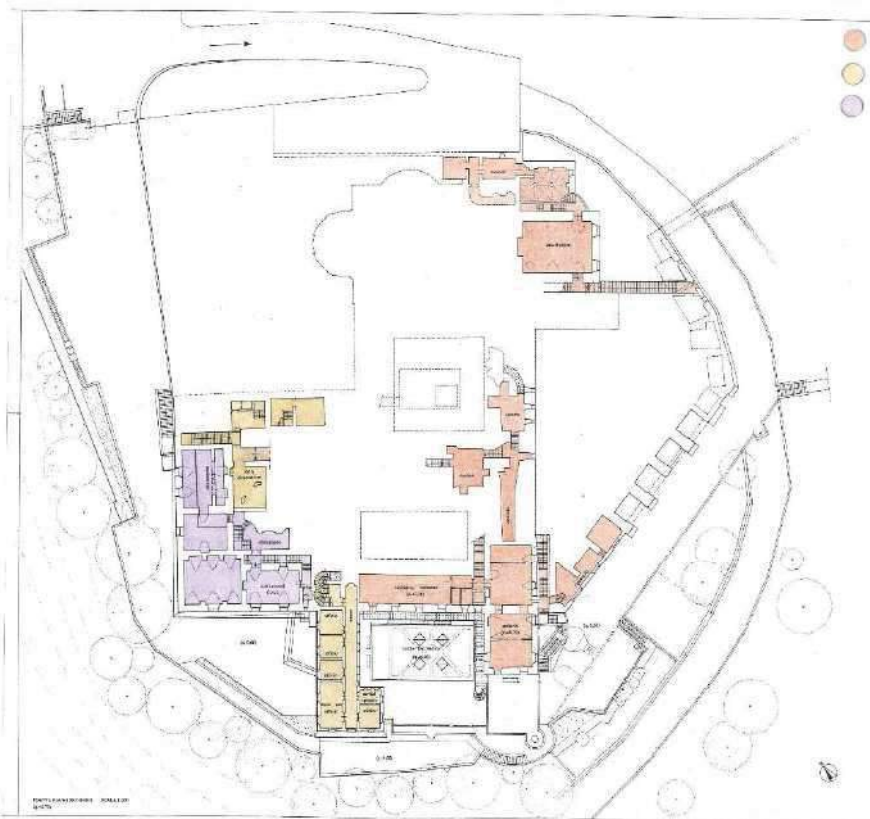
Pianta piano seminterrato; in giallo, nella zona sud, la biblioteca CAI, in rosso la biblioteca conventuale
